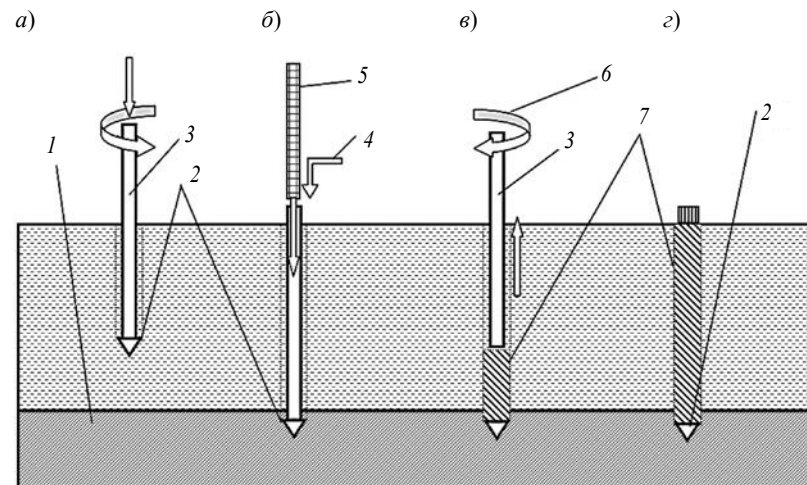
Технологическая последовательность устройства свай: 1 – плотный грунт; 2 – теряемый башмак; 3 – обсадная труба; 4 – подача бетона бадьей или бетононасосом; 5 – арматурный каркас; 6 – направление вращения обсадной трубы; 7 – свая в грунте
